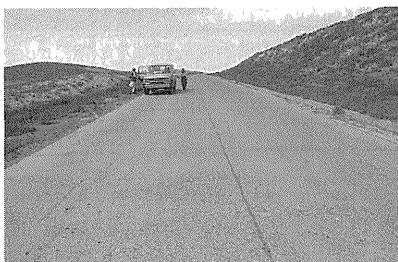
旧ロシア政府が作ったコンクリート舗装道路
